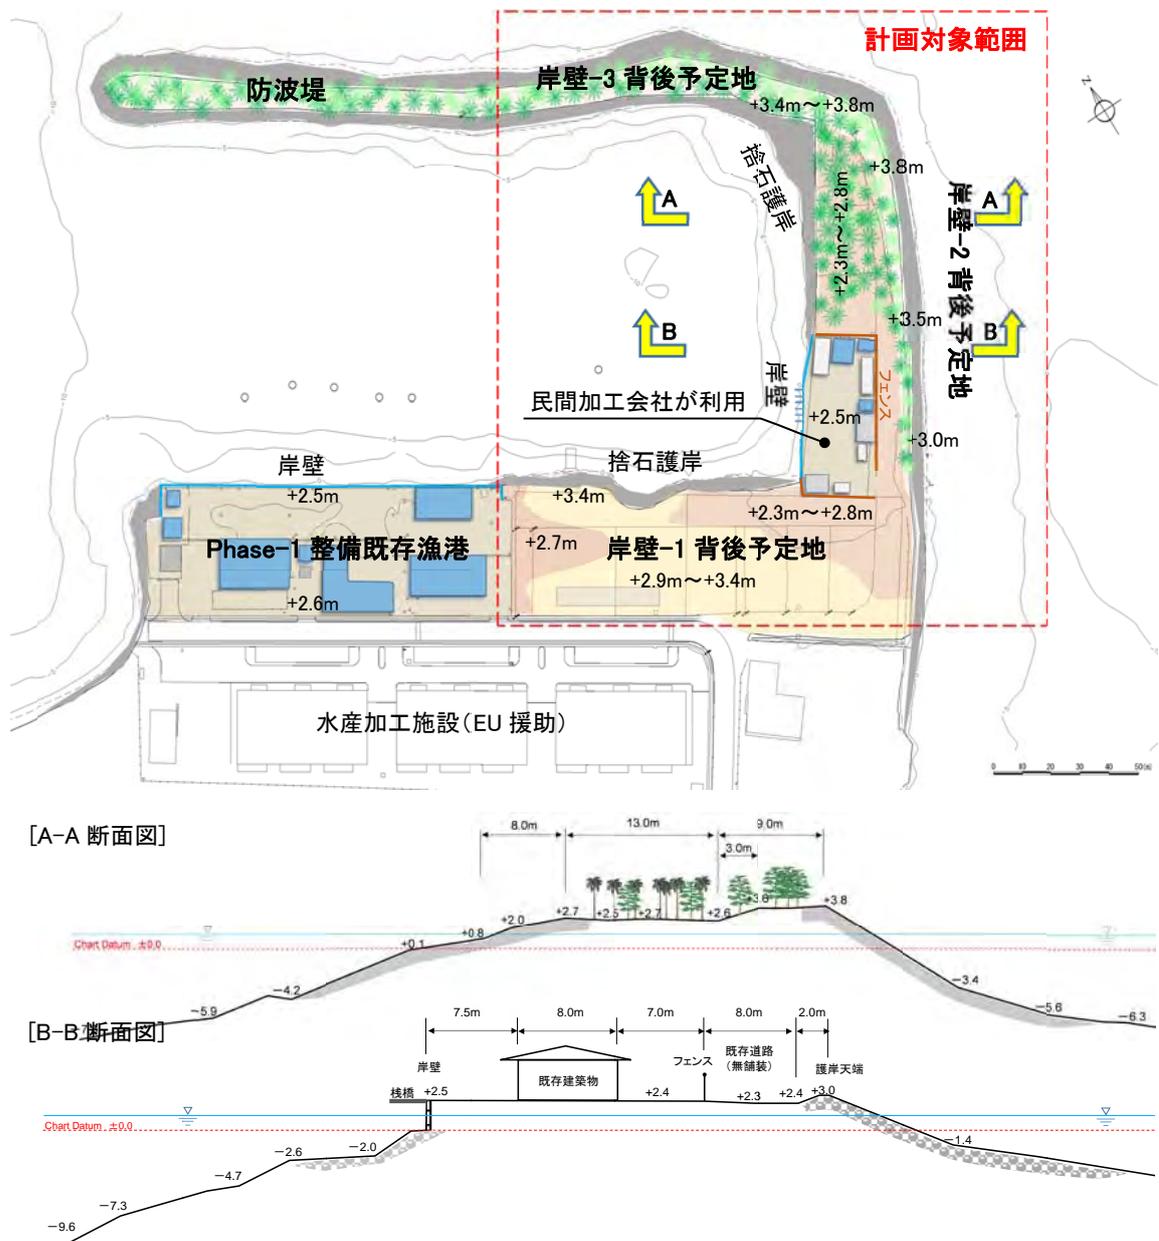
(5) 計画対象範囲の土地利用平面図及び土地利用断面図
